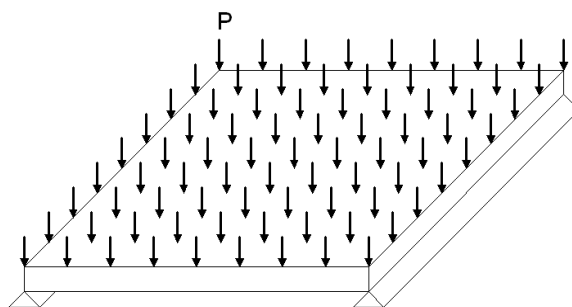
Estrutura de uma laje com um carregamento uniformemente distribuído P.
